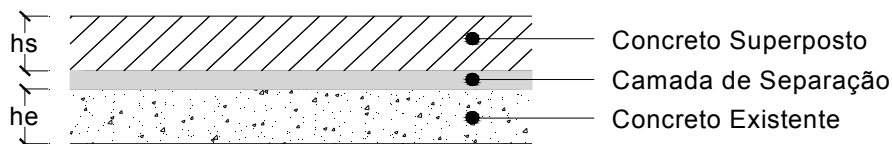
Pavimento superposto sem aderência (DNIT, 2010)
